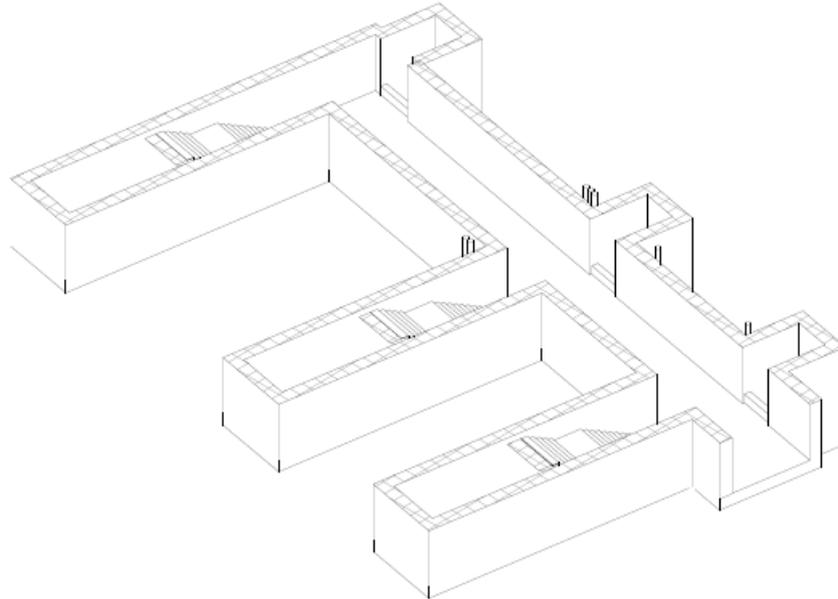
Nuovo sottopasso di stazione SL02 - Spaccato assometrico
